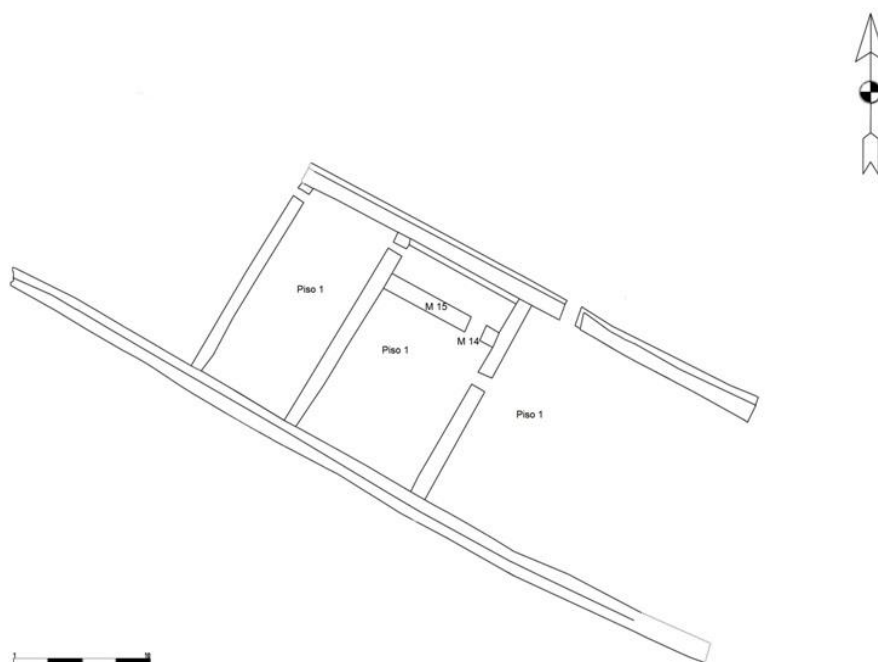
(2).- Fase constructiva 4: planta
